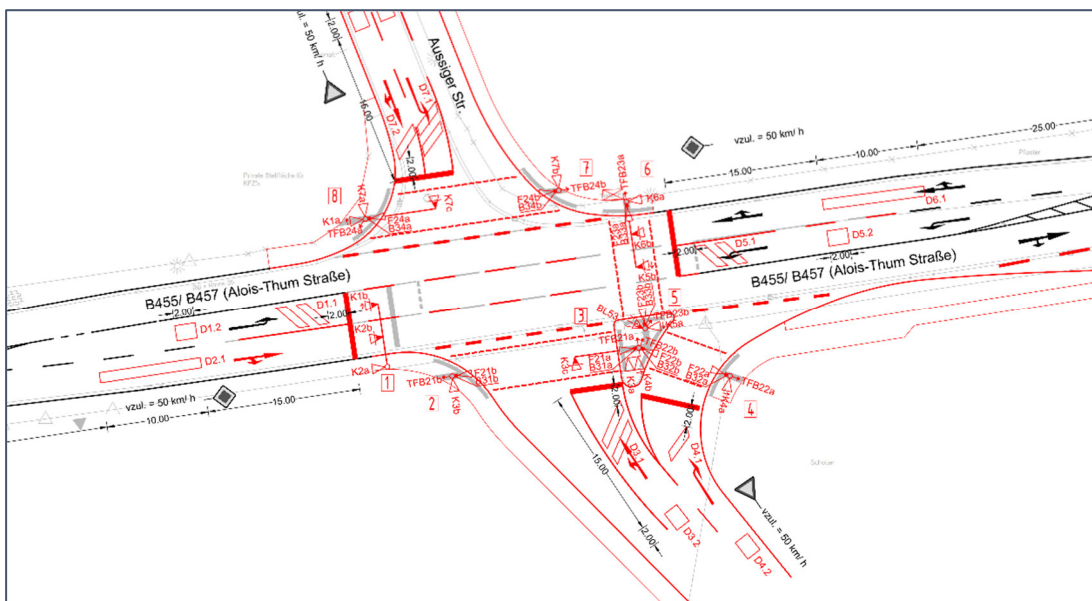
Signallageplan KP B455/ Aussiger Straße/ Anbindung ‚Kahle‘
